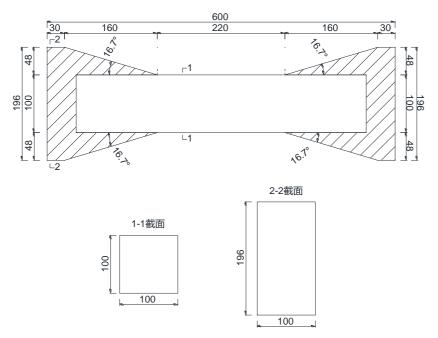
UHPC 轴拉试件设计尺寸图 (mm)
